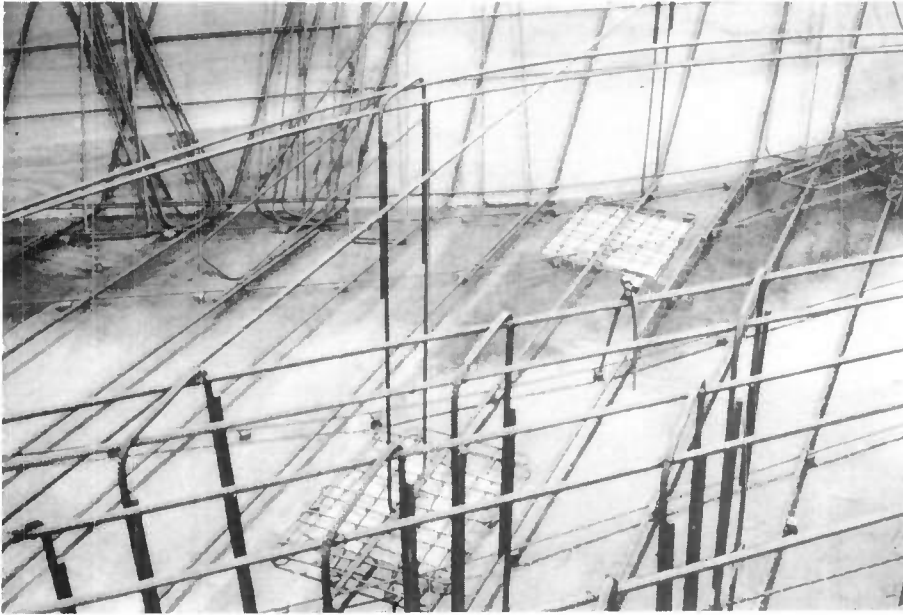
Frettage en place au droit des appareils d'appui . Ici les bossages supérieurs sont préfabriqués.
